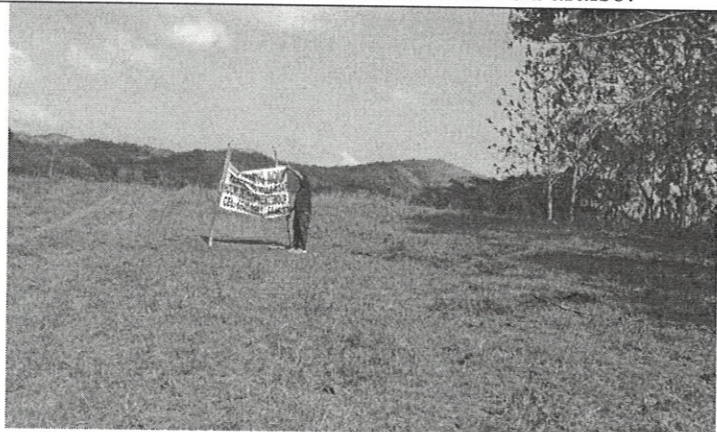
Superficie del proyecto denominado Construcción Residencial Villas del Rosario a desarrollarse en la comunidad de Nuevo Paraíso.
